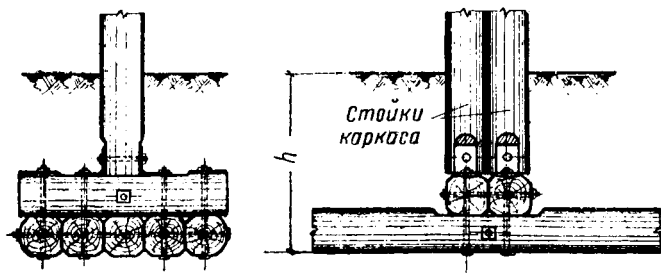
Деревянные растверковые фундаменты каркасных зданий
